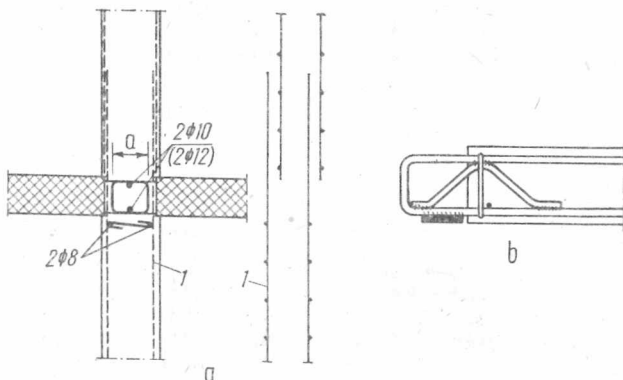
Îmbinarea diafragmelor armate cu plase sudate cu planșee prefabricate rezemate pe console de beton :
